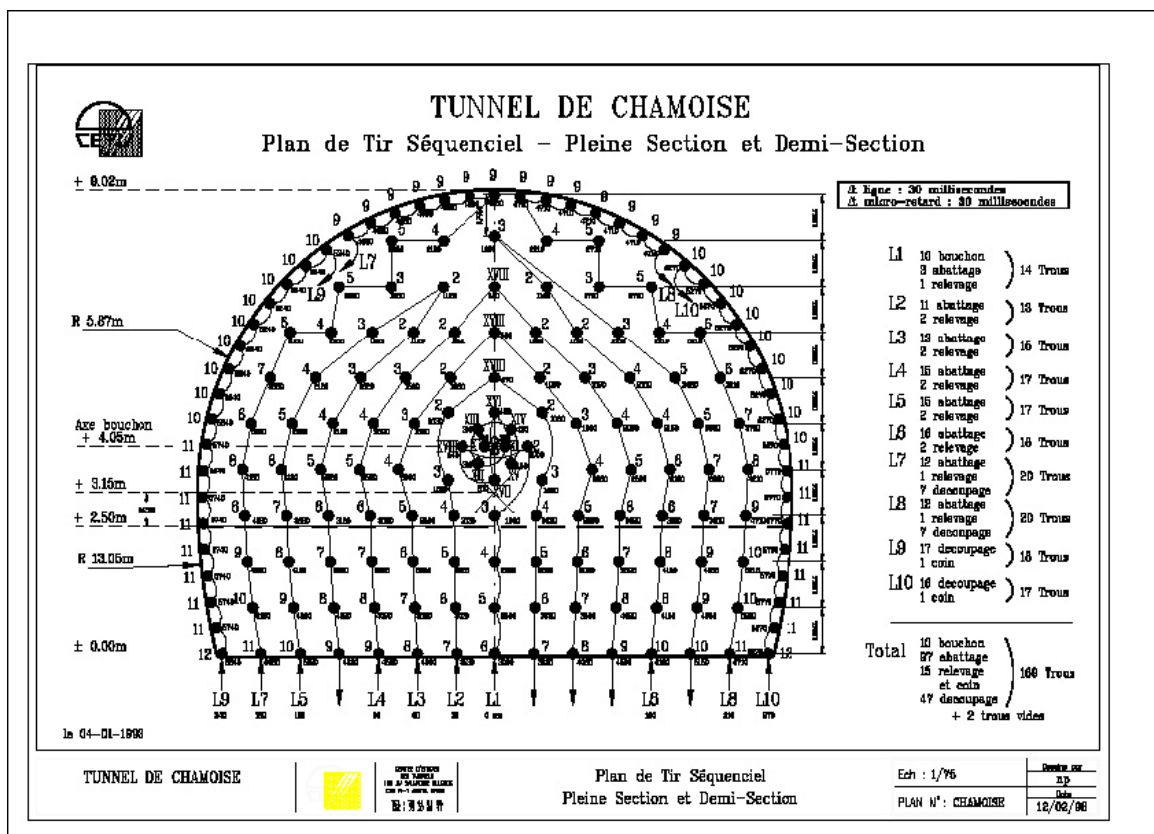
plan de tir du front de taille d'un tunnel. [17]
